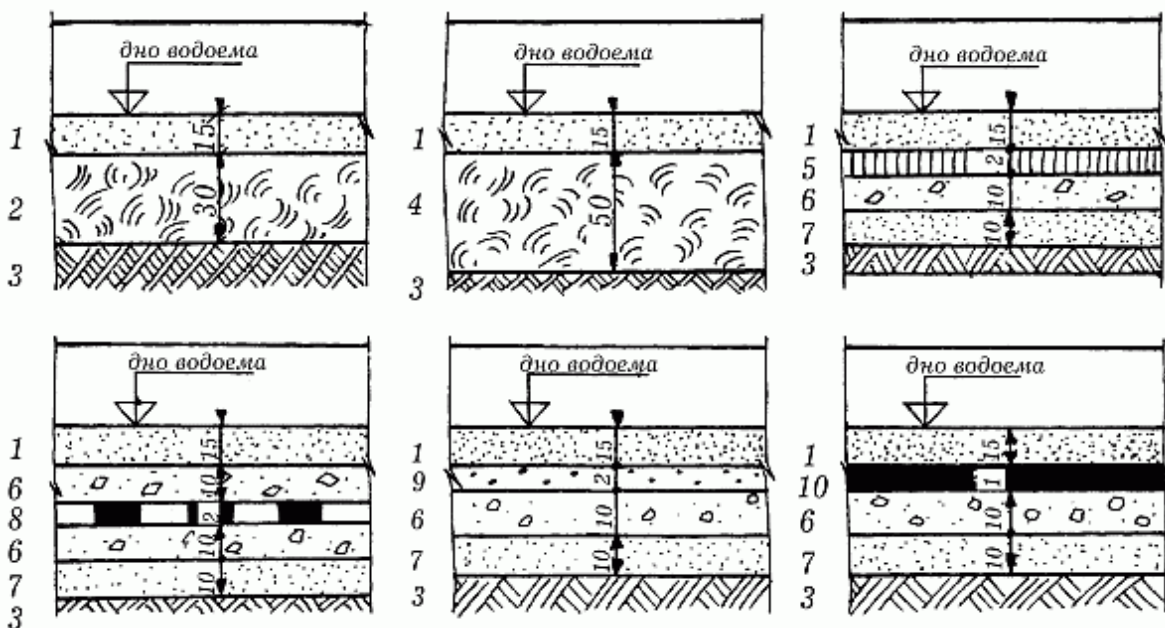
Типы гидроизоляции ложа бассейнов: 1 – песчаная пригрузка; 2 – мятая глина; 3 – уплотненный грунт; 4 – жирный суглинок; 5 – песчаный асфальтобетон; 6 – бетон марки 200; 7 – песчаная подготовка; 8 – два слоя гидроизола по горячей битумной мастике; 9 – торкретирование бетоном марки 300; 10 – гидроизоляция битумной эмульсией два раза
